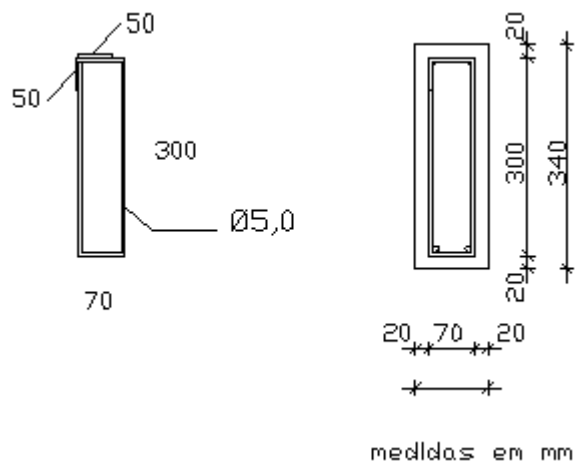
Detalhe das armaduras de cisalhamento das vigas
